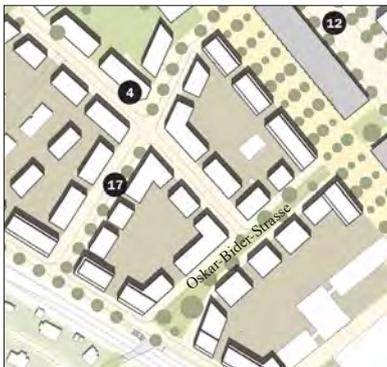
Randbebauung mit grösseren zusammenhängenden Aussenräumen (Team Van de Wetering)
